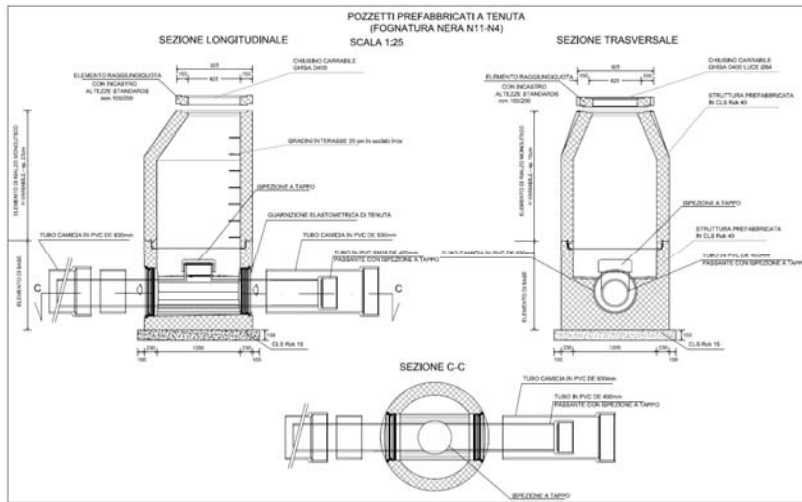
Pozzetti prefabbricati a tenuta nel tratto di interferenza con la zona di rispetto allargata
